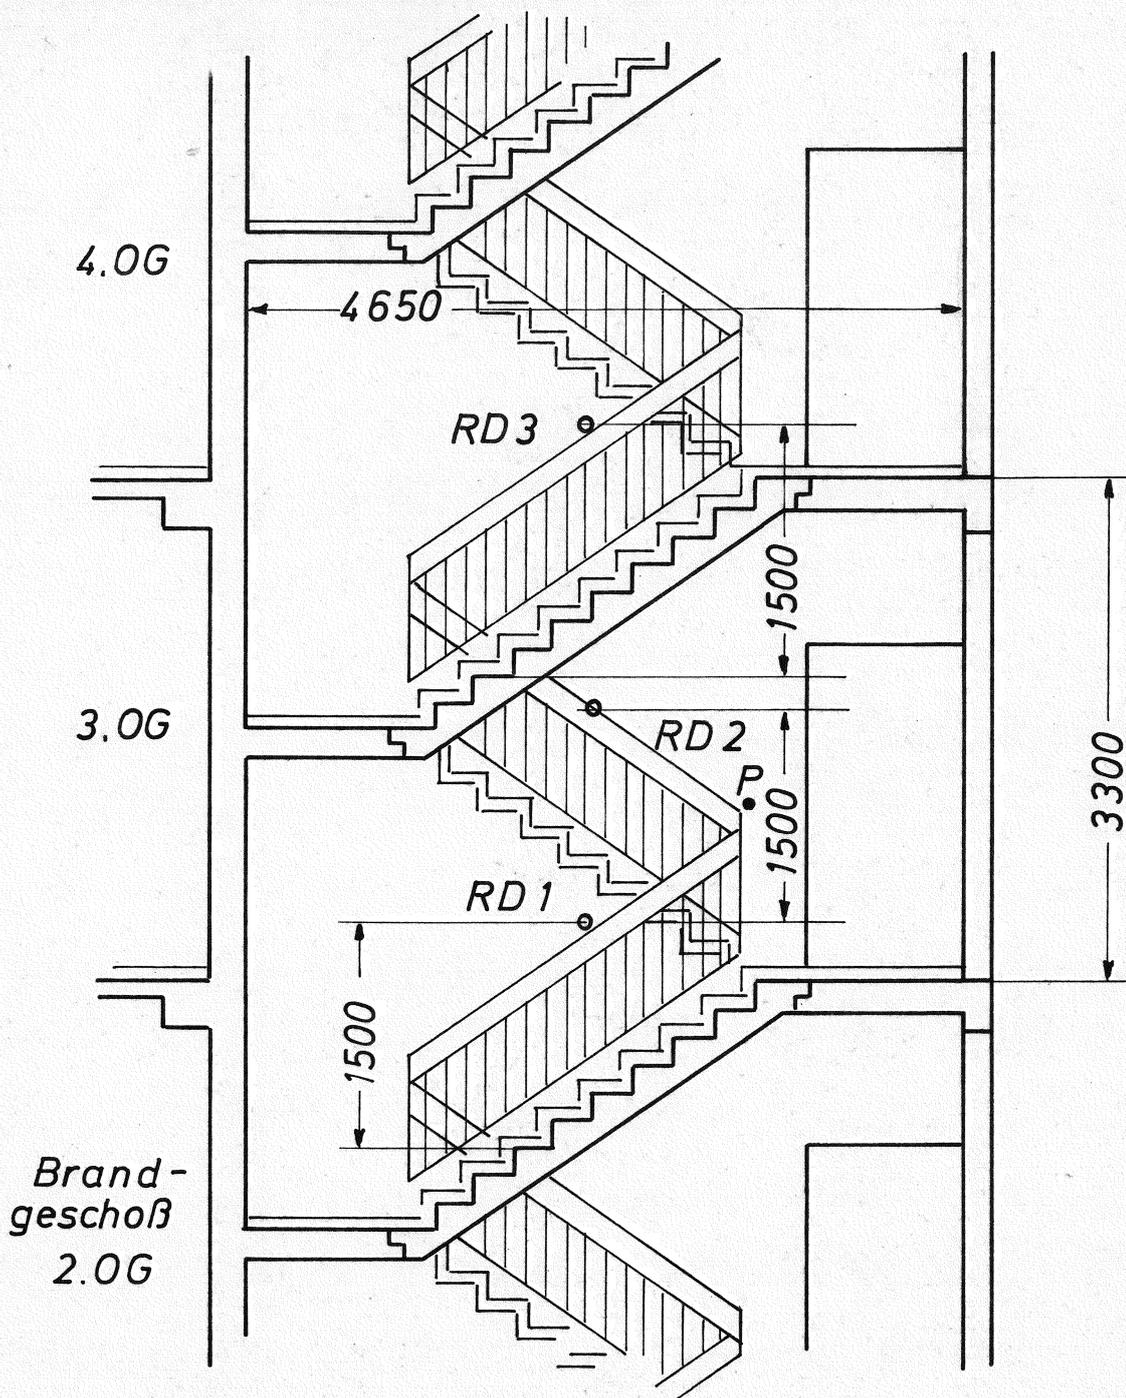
Bürogebäude Hamburg, Dammtorstraße 29
